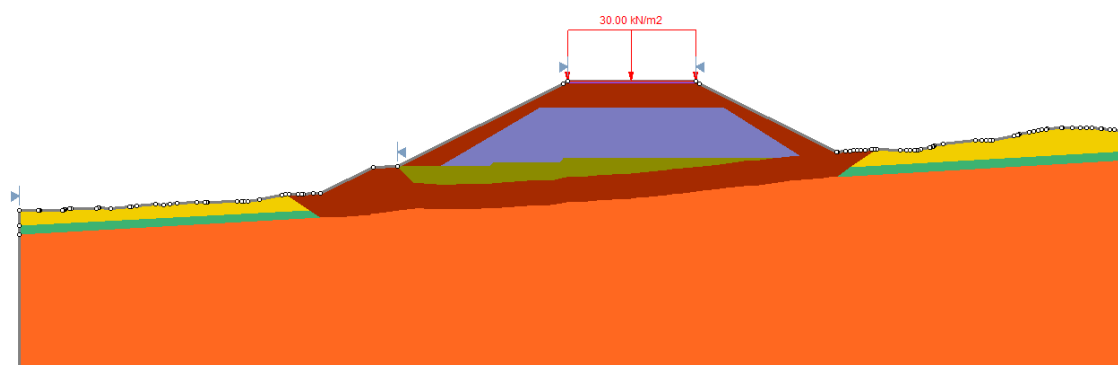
Perfil transversal de cálculo ao Pk 13+475.
